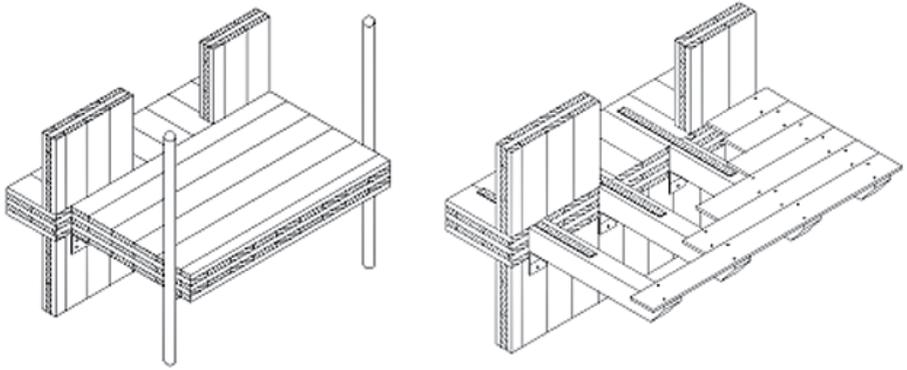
Balcone realizzato mediante un pannello XLAM in appoggio su staffe metalliche fissate alle pareti perimetrali e su pilastri esterni oppure mediante travetti a sbalzo, ancorati a taglio con squadrette metalliche e a flessione con nastri forati
